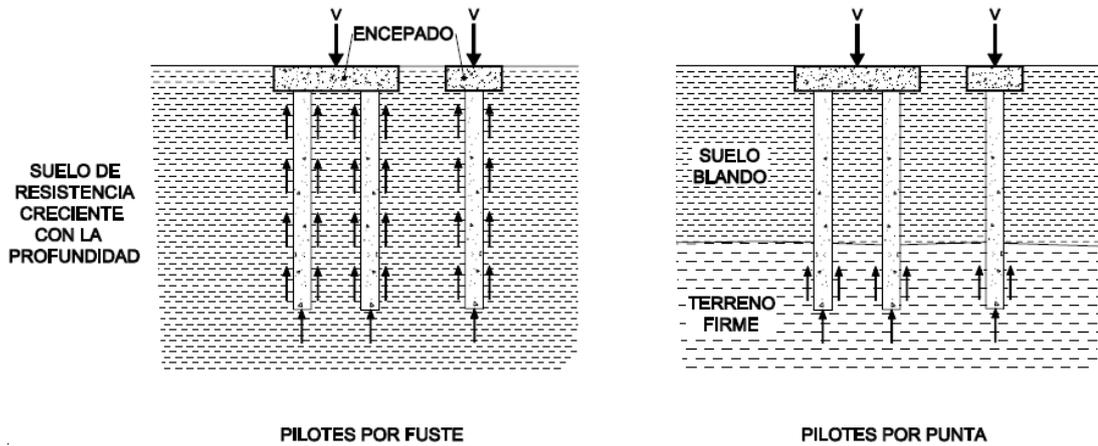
Cimentación de pilotes por fuste y por punta (Fuente: [29])
